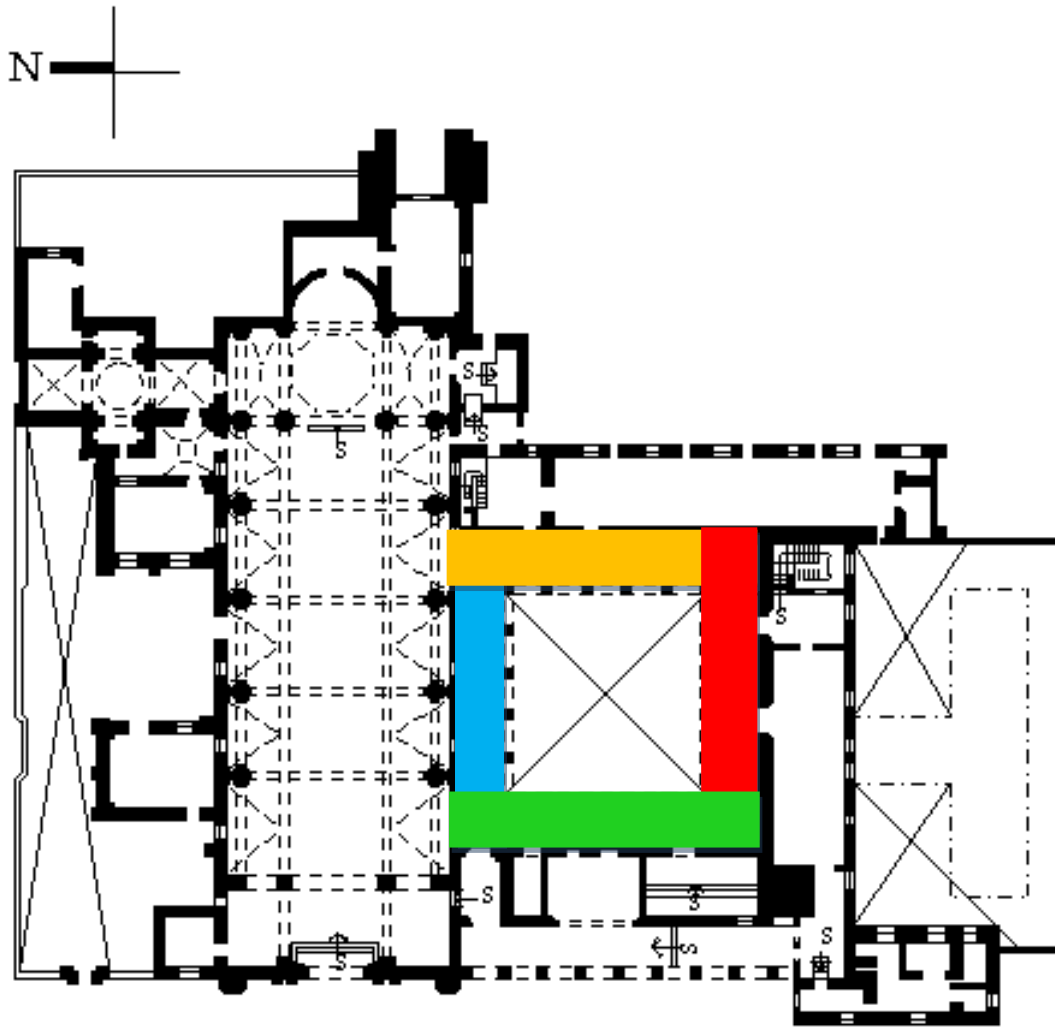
Planta arquitectónica del conjunto de San Juan Bautista. Galerías del claustro bajo.³⁷²
